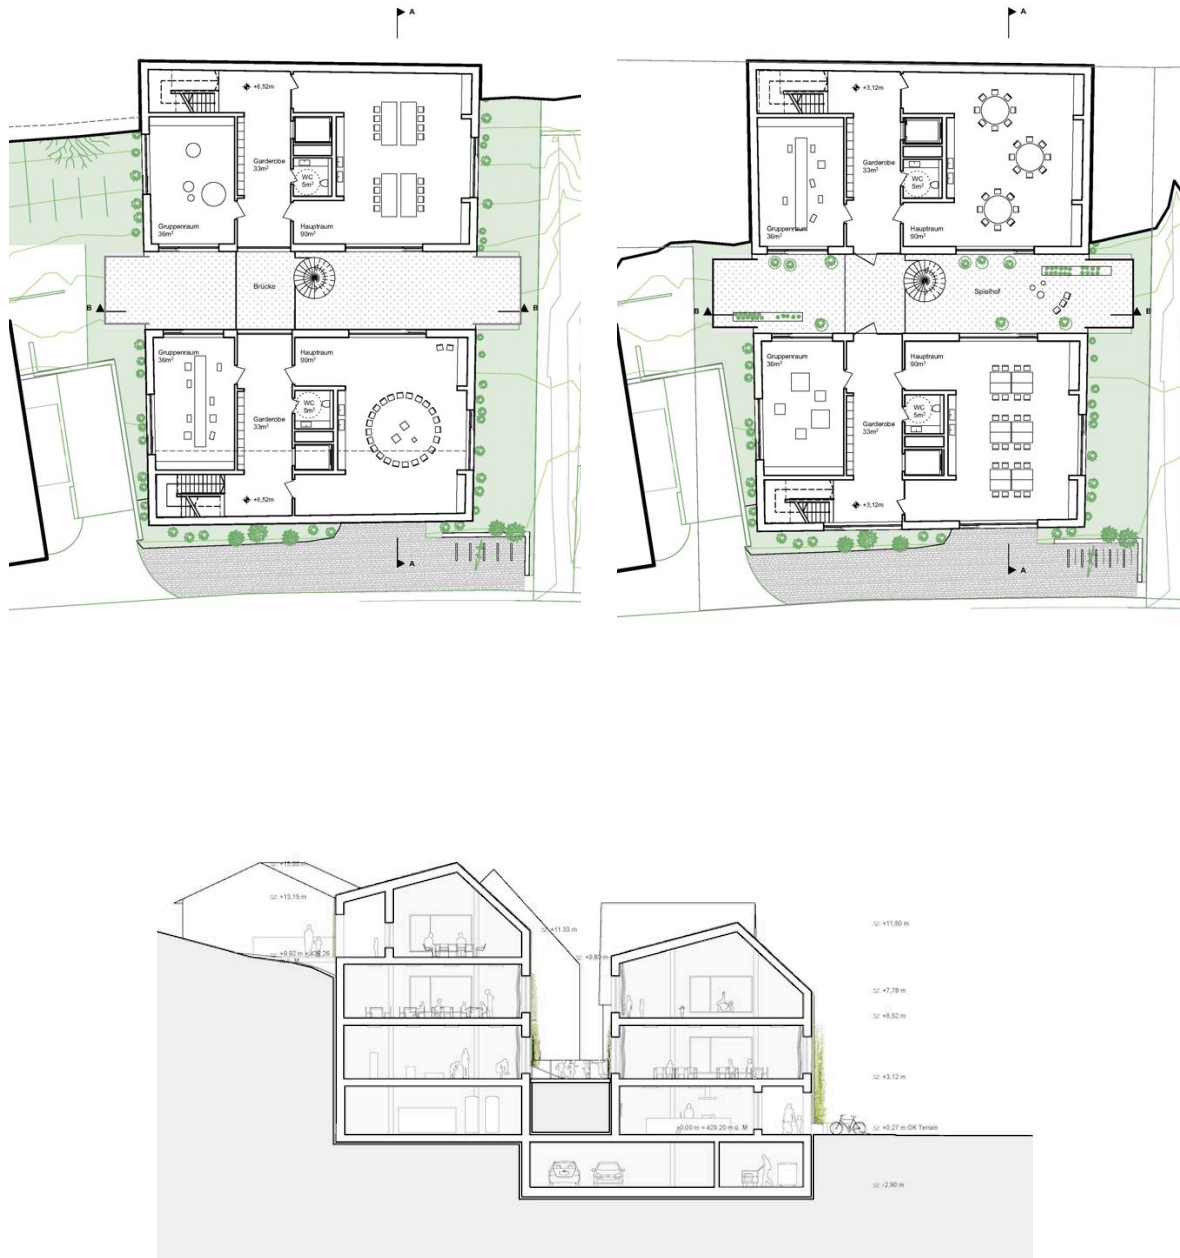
Grundrisse und Schnitt (v. o. l. n. u. r.)
